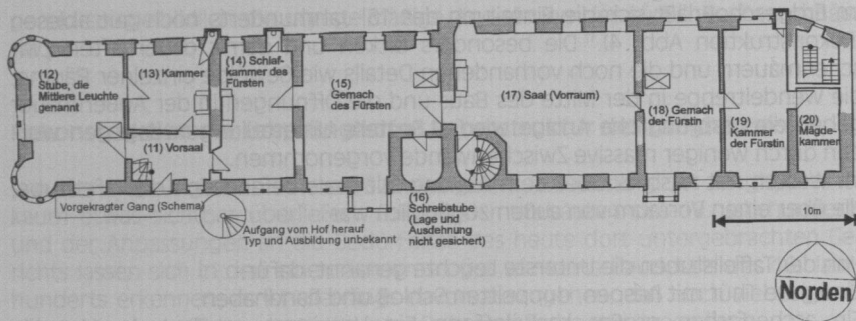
Langhaus. Grundriß des ersten Obergeschosses. Rekonstruktion des Zustandes 1570 bzw. 1606
